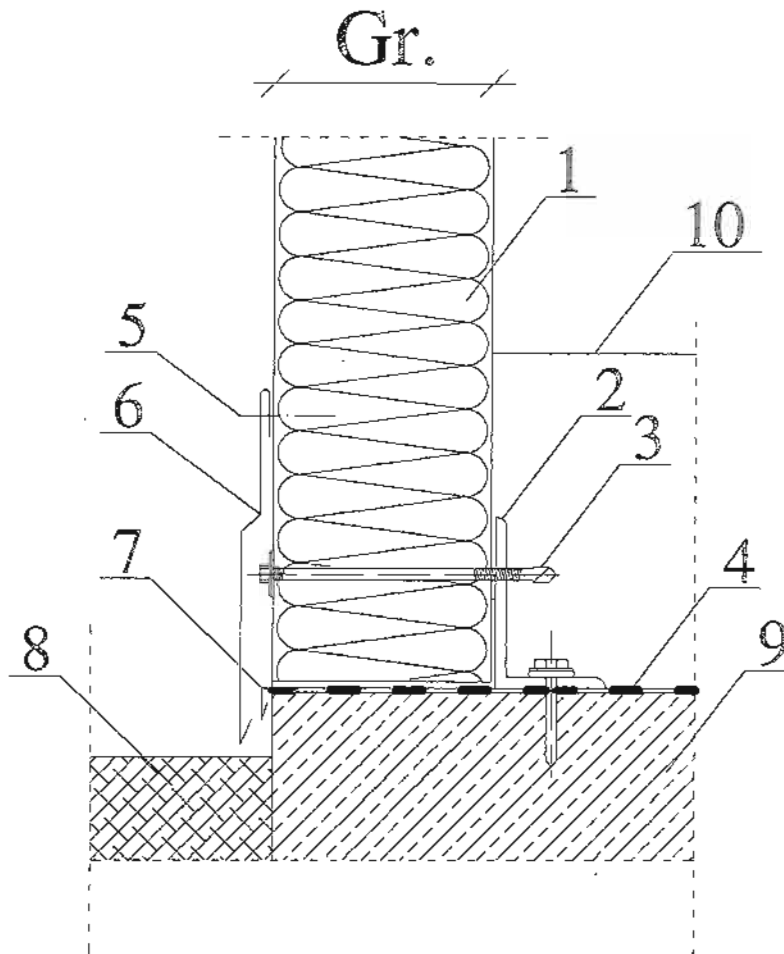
Połączenie płyty ściennej z cokołem murowanym lub betonowym
